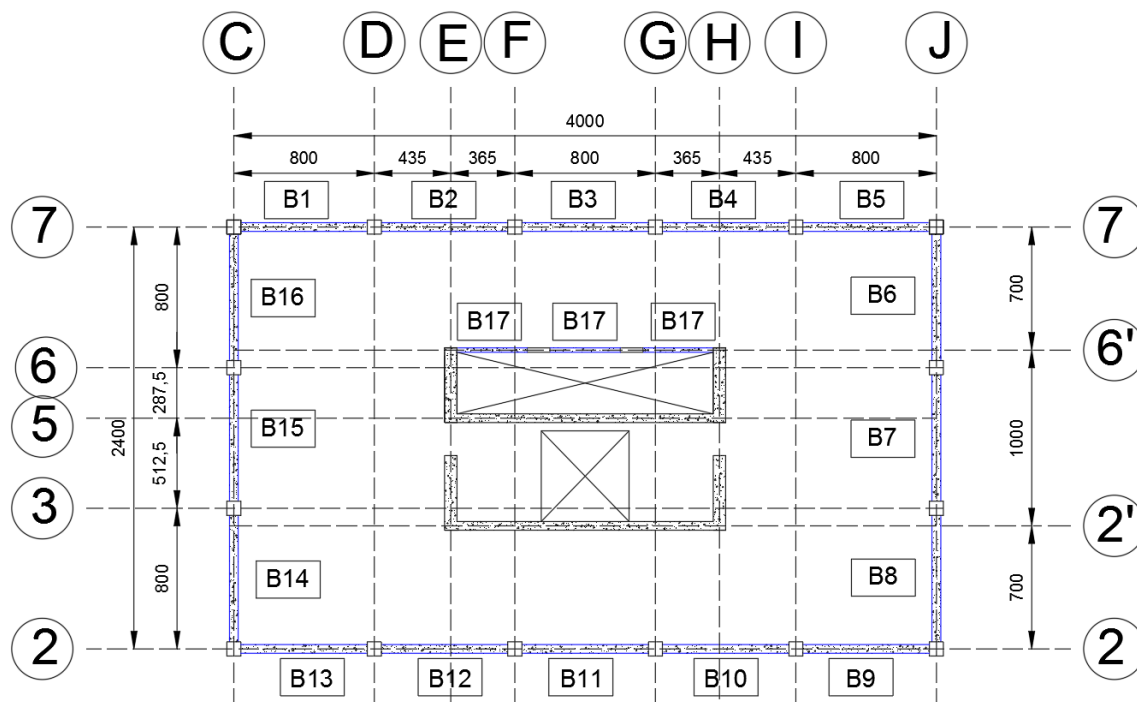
Planta típica de vigas, Pisos 1 al 16.
